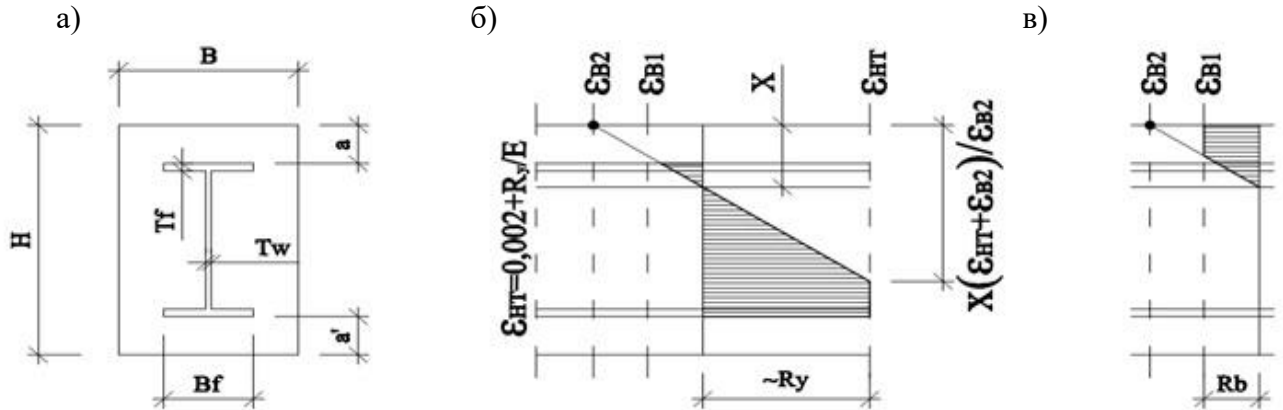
Случай 2: а) сечение изгибаемого элемента; б) эпюра нормальных напряжений в сечении жёсткой арматуры; в) эпюра нормальных напряжений в бетоне
